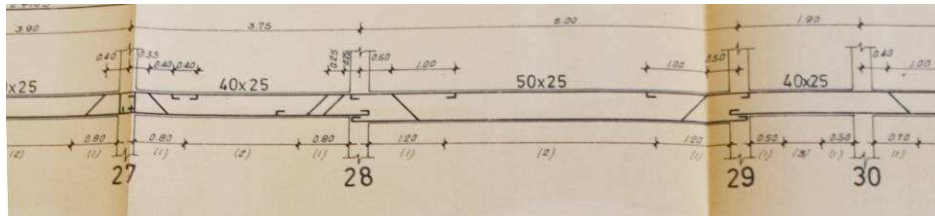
Despiece de armado de vigas. Edificio ficha 222C.017, 1972.
